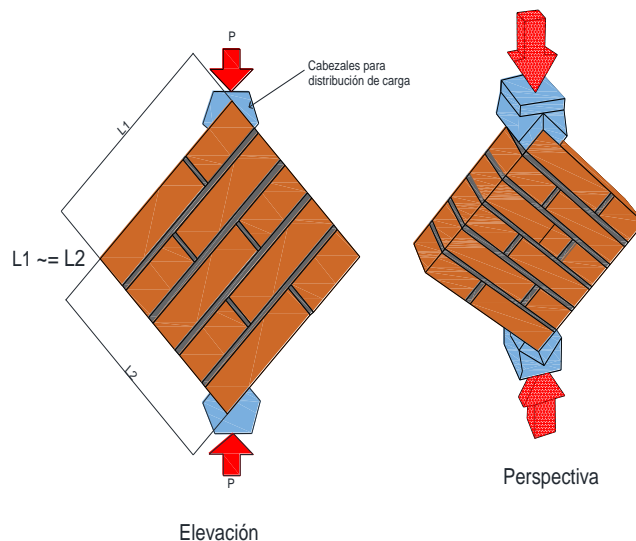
Murete para prueba de compresión diagonal, fuente: NTC2017
